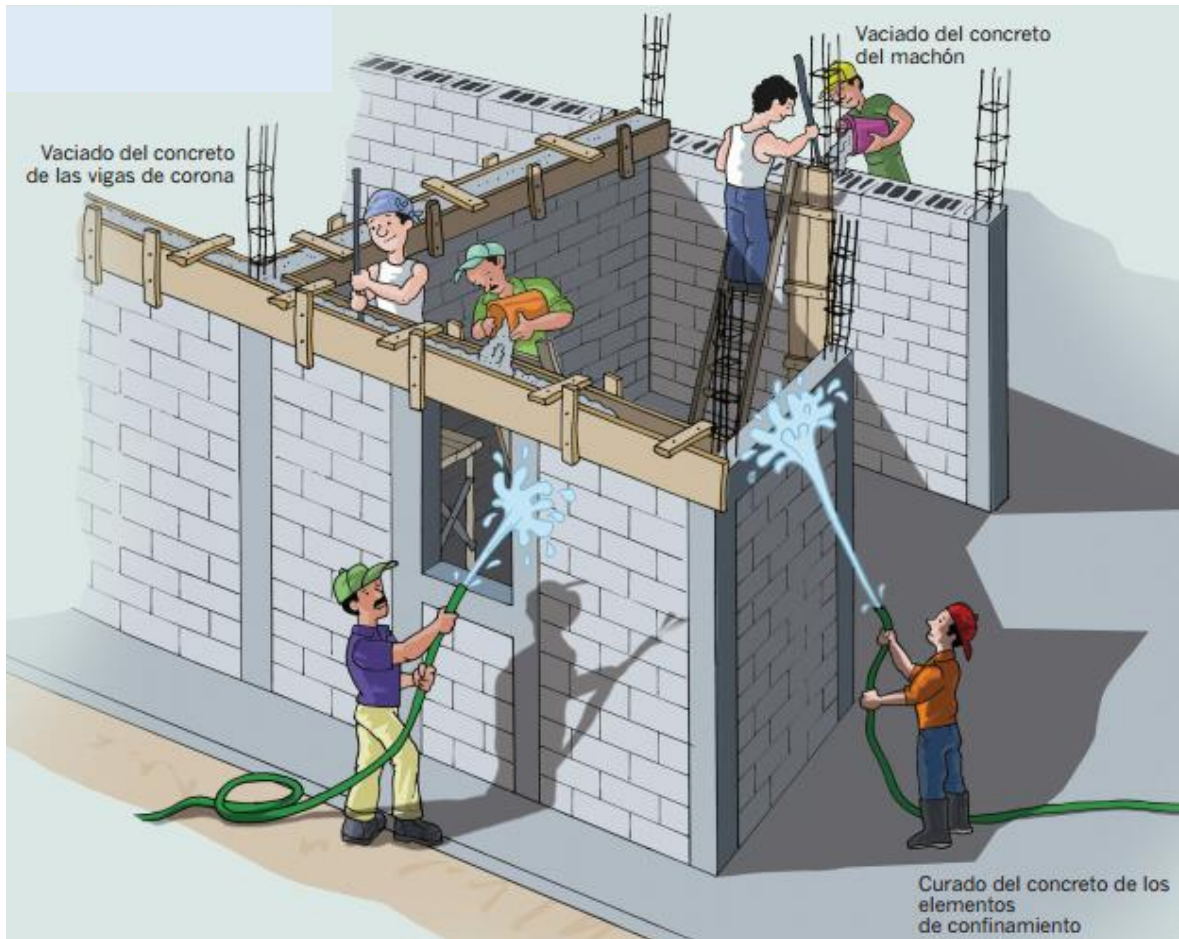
Vaciado de los elementos de confinamiento de concreto armado. Fuente: Vivienda de mampostería confinada con elementos de concreto armado. Angelo Marinilli 2013. Ilustración realizada por: Douglas Muñoz
